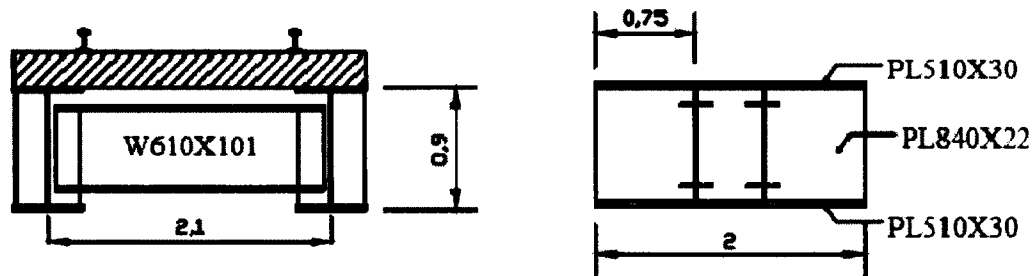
Pont bi-poutres - Section transversale et élévation - Section G
